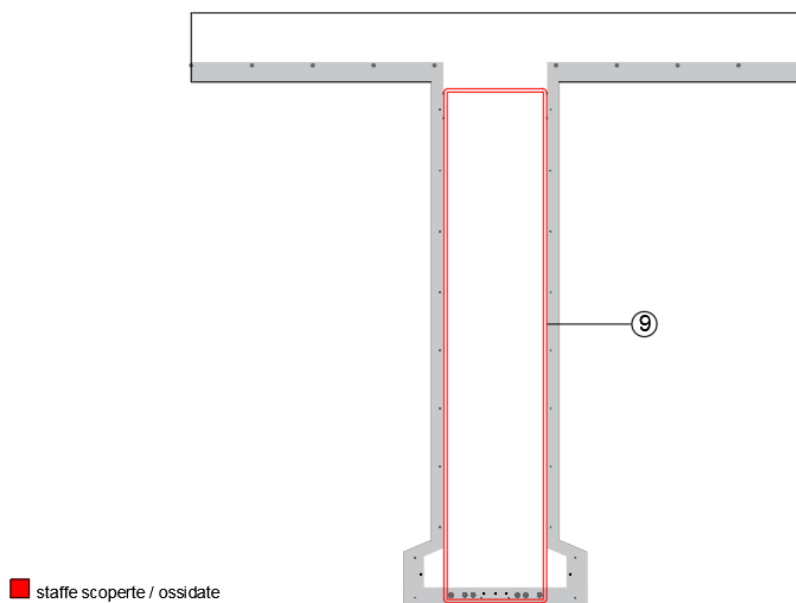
Ponte sul torrente Mavigliano, deterioramento sezione di testata Caso xx_ev3
